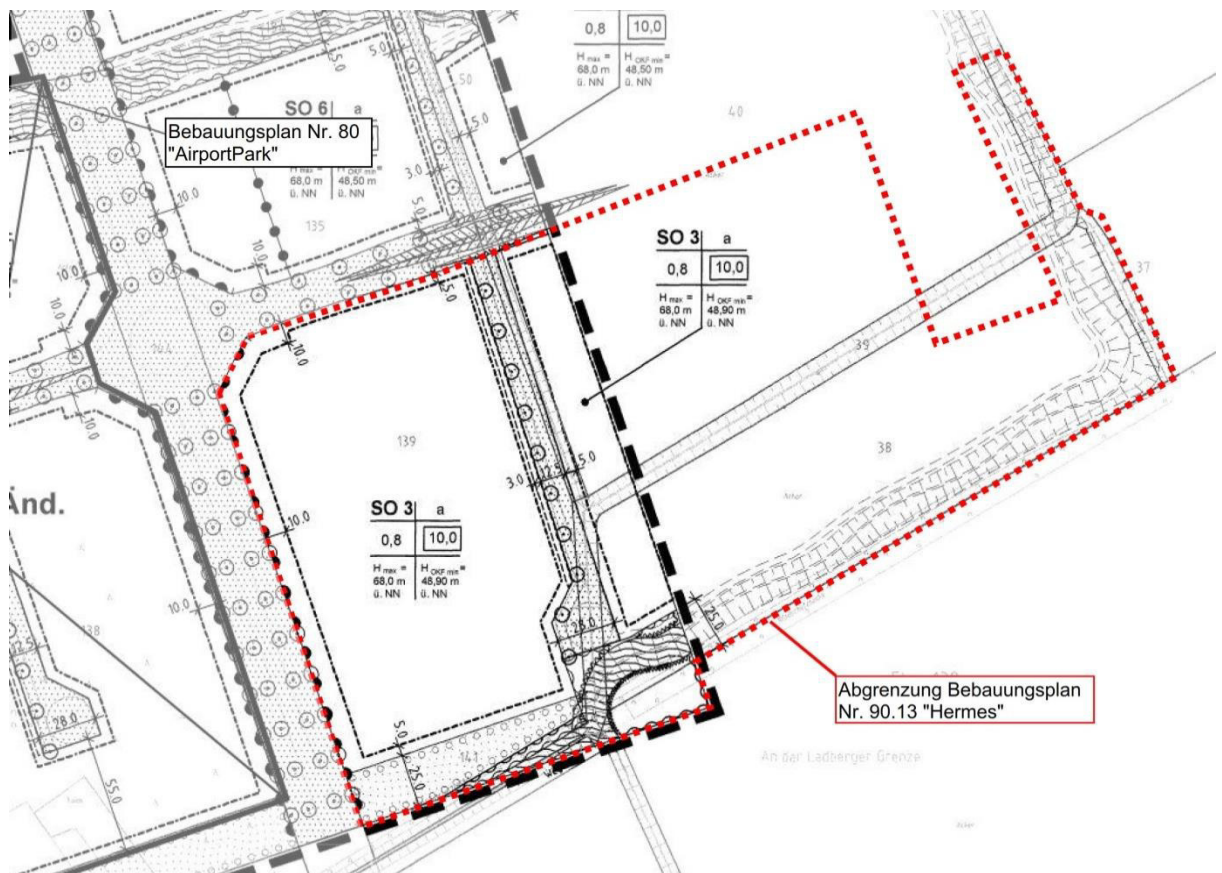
Ausschnitt rechtskräftiger B-Plan Nr. 80 „AirportPark“, 1. Änderung inkl. neuer Abgrenzung B-Plan Nr. 90.13 „Hermes“
